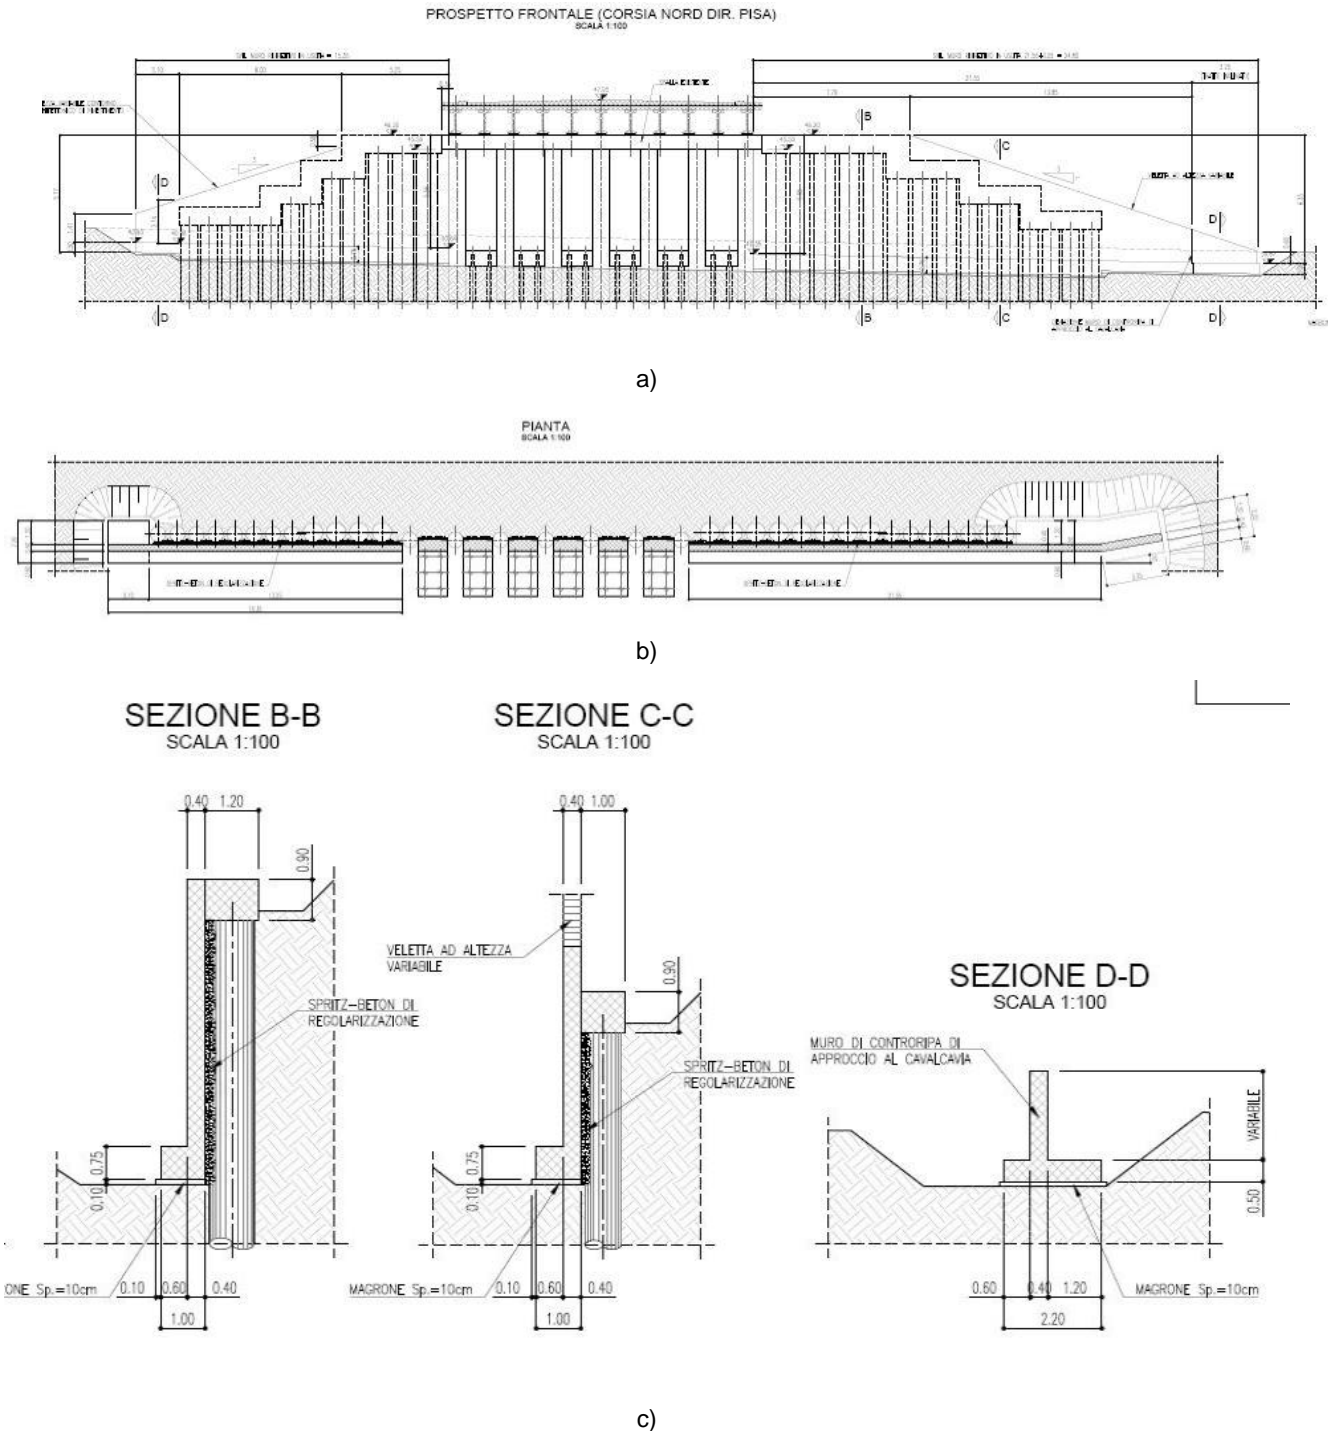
Intervento CV006: profilo longitudinale a); stralcio planimetrico b); sezione tipo in corrispondenza muro di sostegno c).
